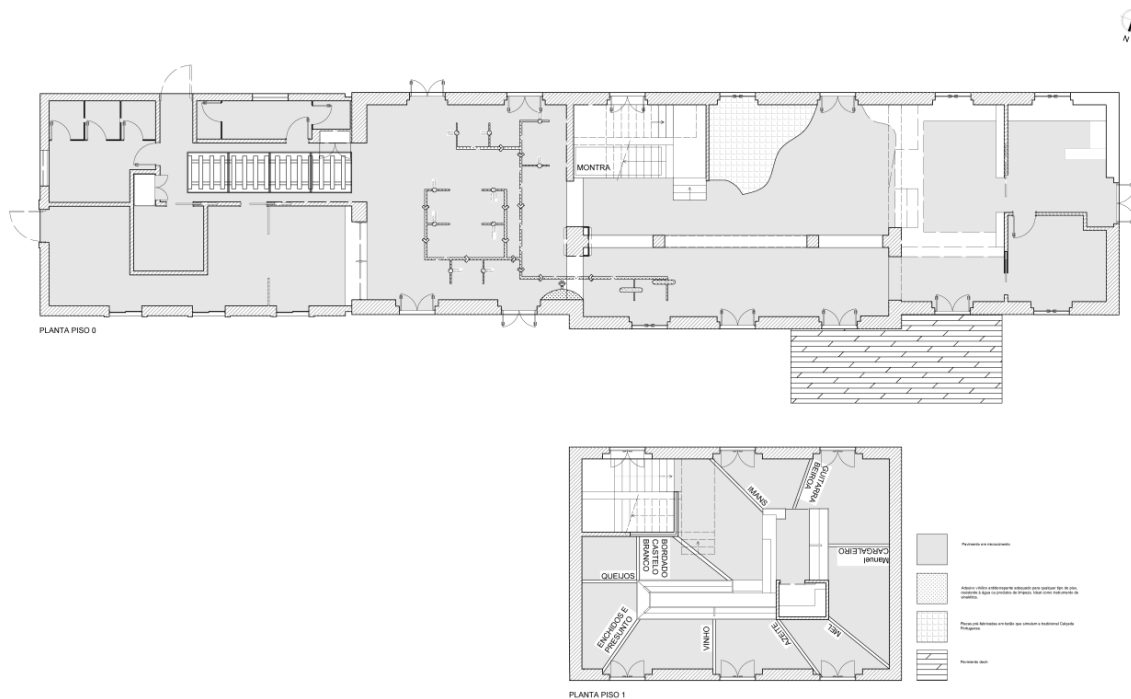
Planta de Pavimento, Piso 0 e Piso 1
